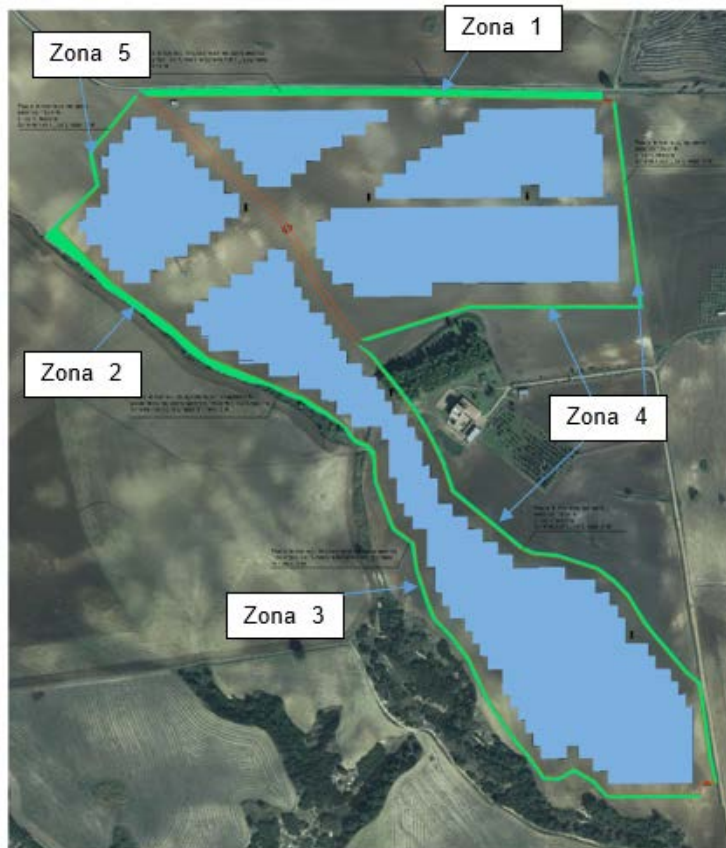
Stralci elaborato grafico delle Mitigazioni perimetrali con vegetazione secondo lo schema 1
